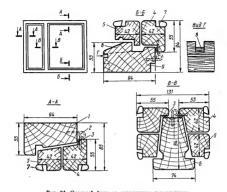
Оконный блок со спаренными переплетами: 1 — бруски коробки (верхний и боковое); 2 — ветая; 3 — удлогизоция прокладка; 4 брусок внутренией створии: 5 — брусок наружной створки; 6 — импост; 7 — раскладка по стеклу; 8 — пропрем для отпода воды; 9 — брусок коробки (нижим).
